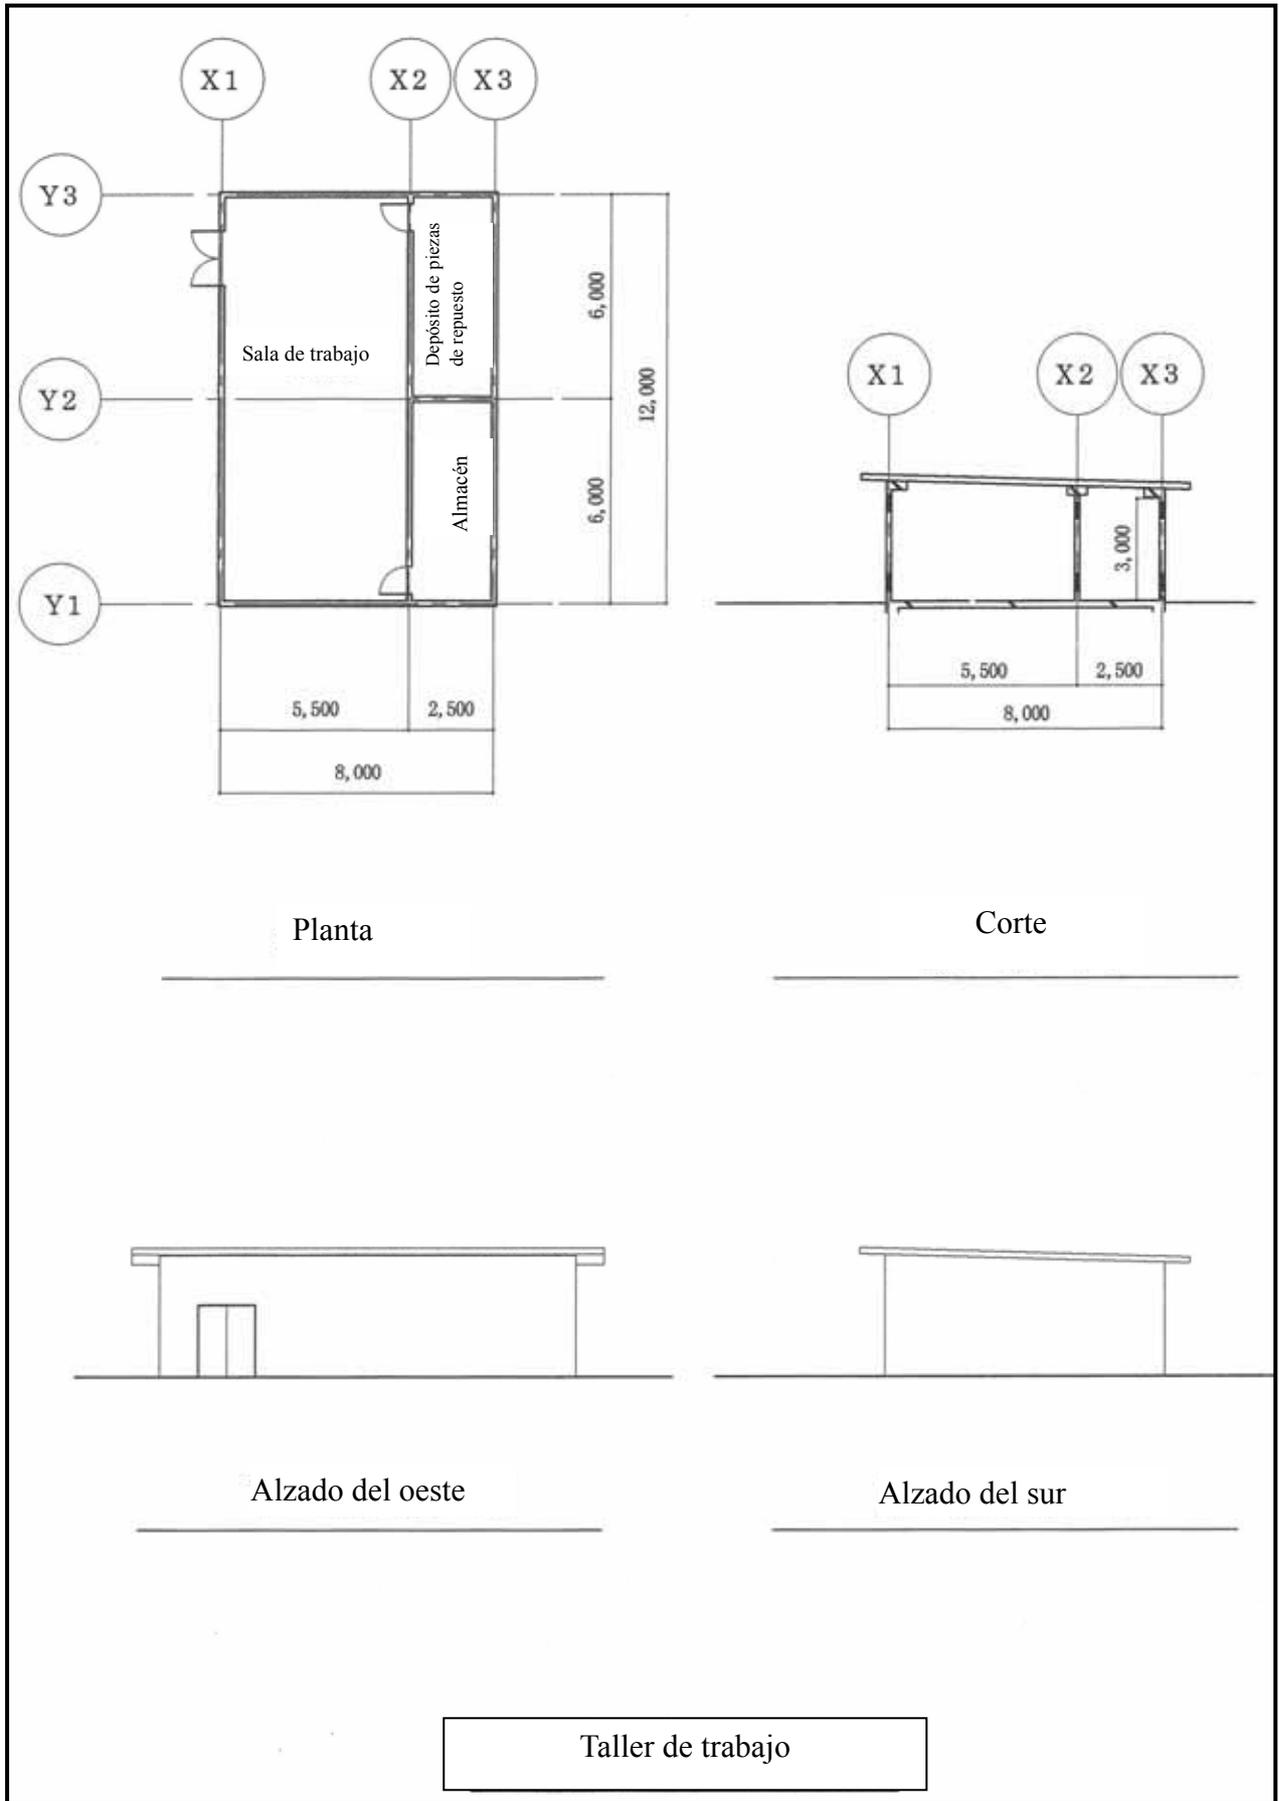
Planta, corte y alzado del taller de trabajo
